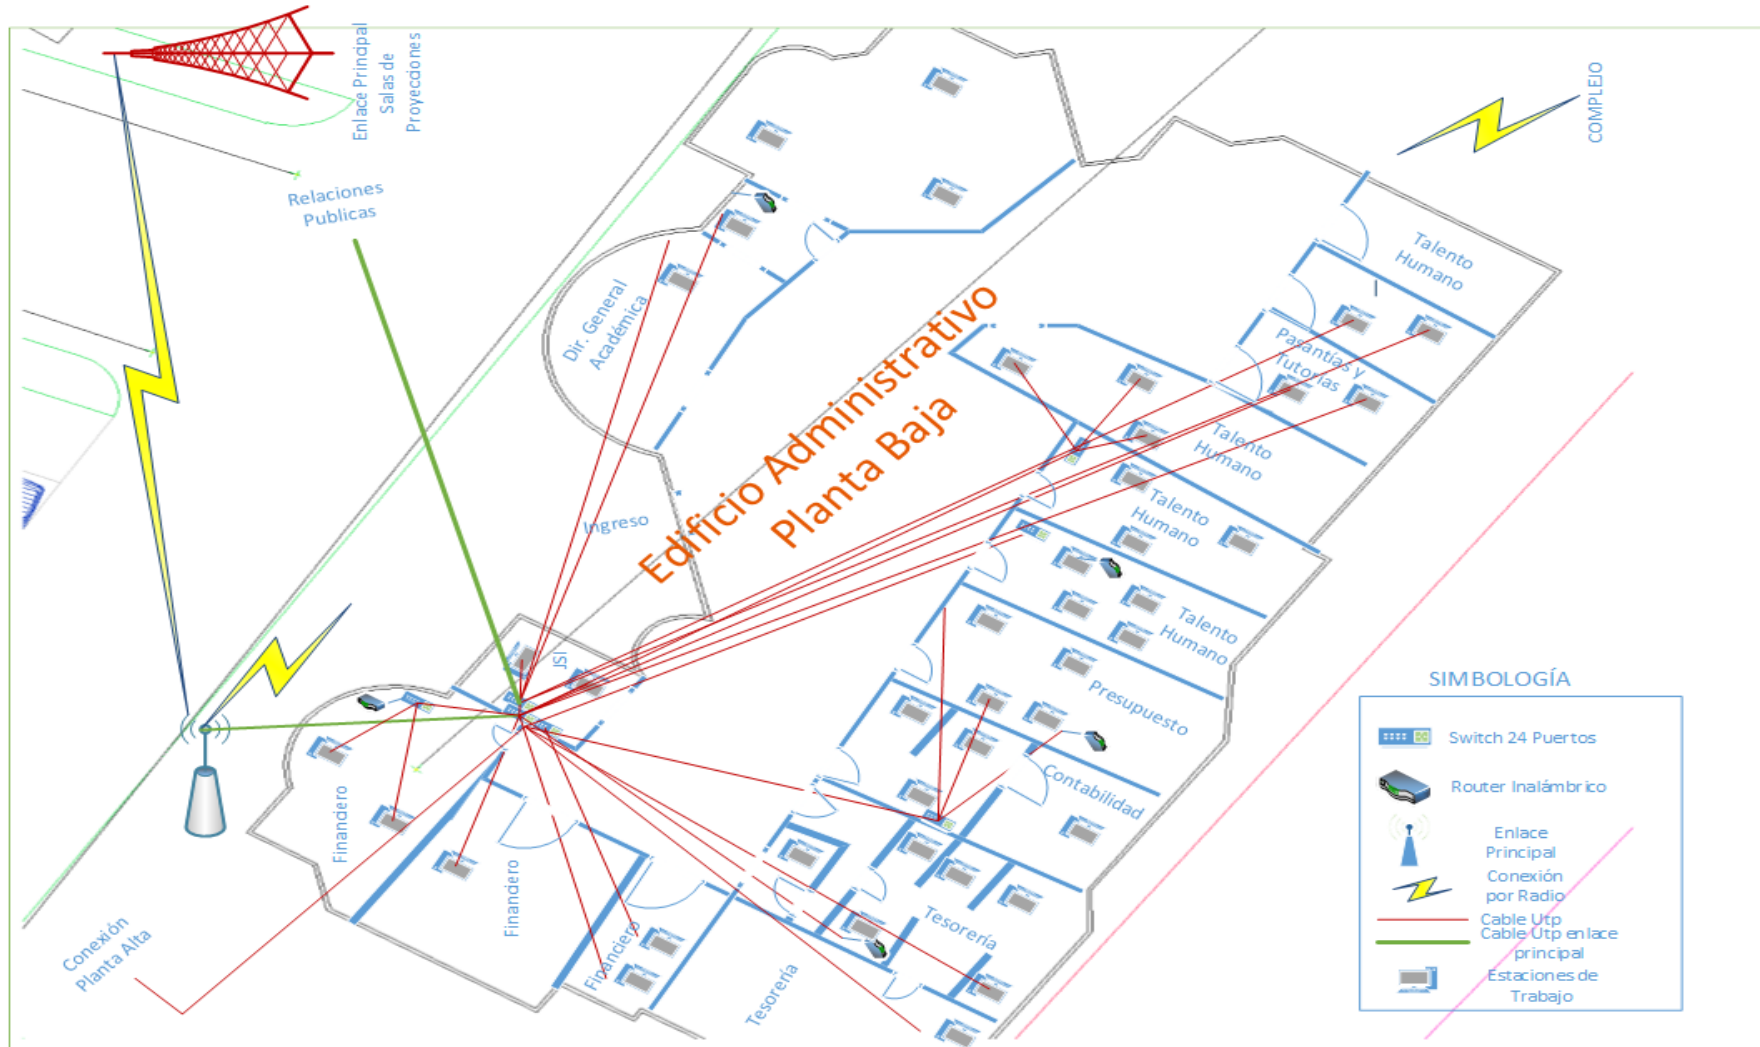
Edificio Administrativo Planta Baja UNESUM.
